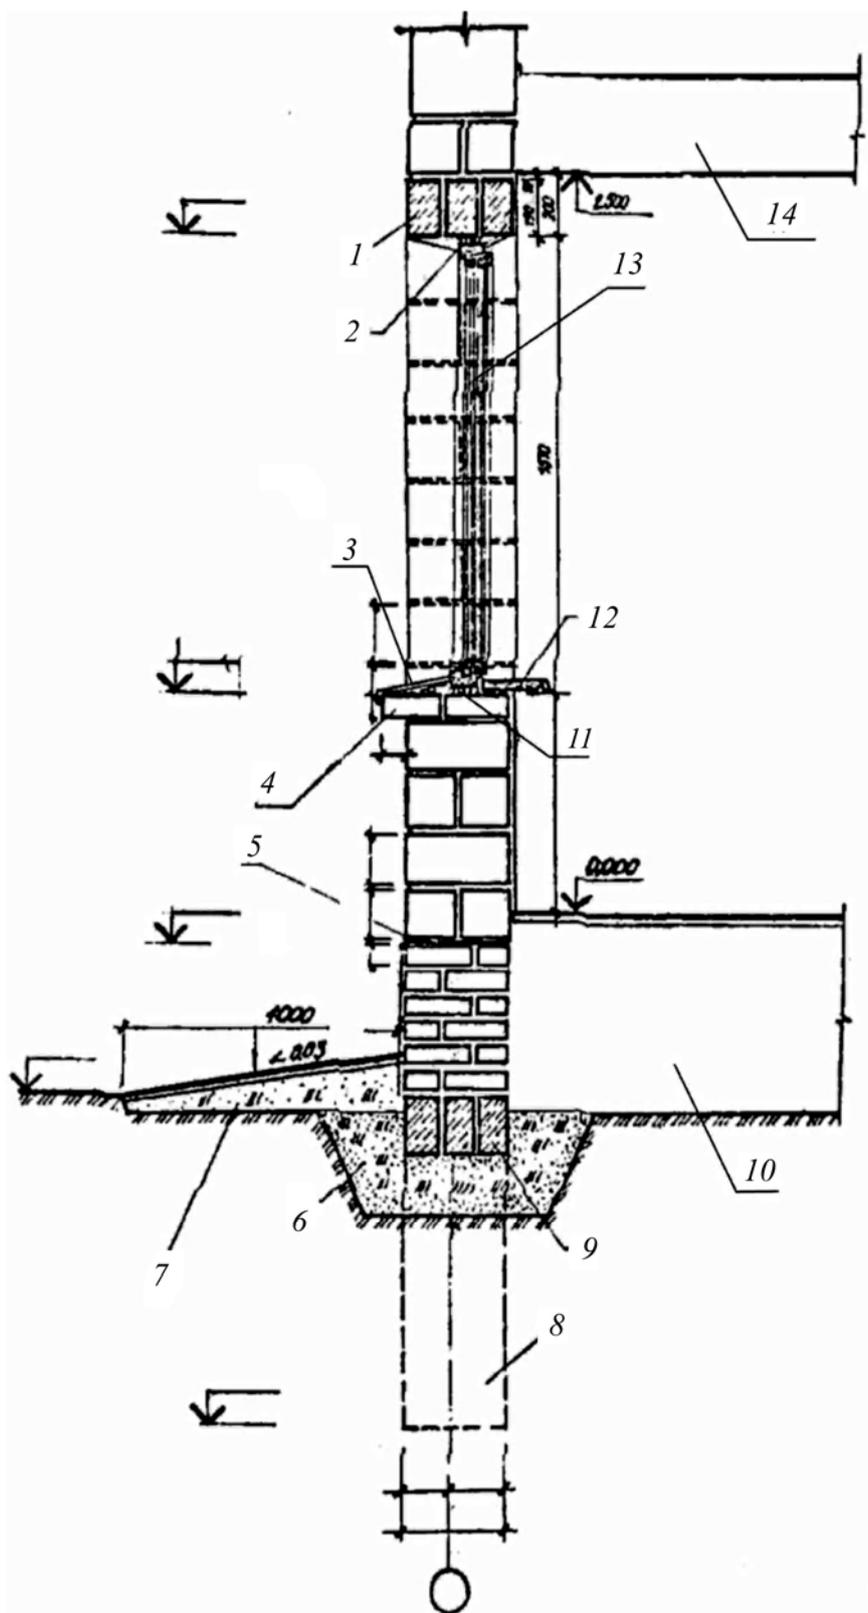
Вертикальная порядовка кладки из легкобетонных камней наружной стены: 1 — брусковая ж/б перемычка; 2 — рубероид; 3 — слив из оцинкованной кровельной стали; 4 — выступ из модульного силикатного кирпича высотой 88 мм; 5 — гидроизоляция 2 слоя толя; 6 — песчаная подсыпка; 7 — отмостка; 8 — фундаментный столб; 9 — железобетонная фундаментная балка; 10 — конструкция пола на грунте; 11 — конопатка; 12 — подоконная доска; 13 — оконный блок со спаренными переплетами; 14 — конструкция междуэтажного перекрытия
